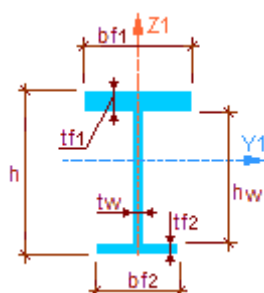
Схема профиля Двутавр сварной несимметричный
